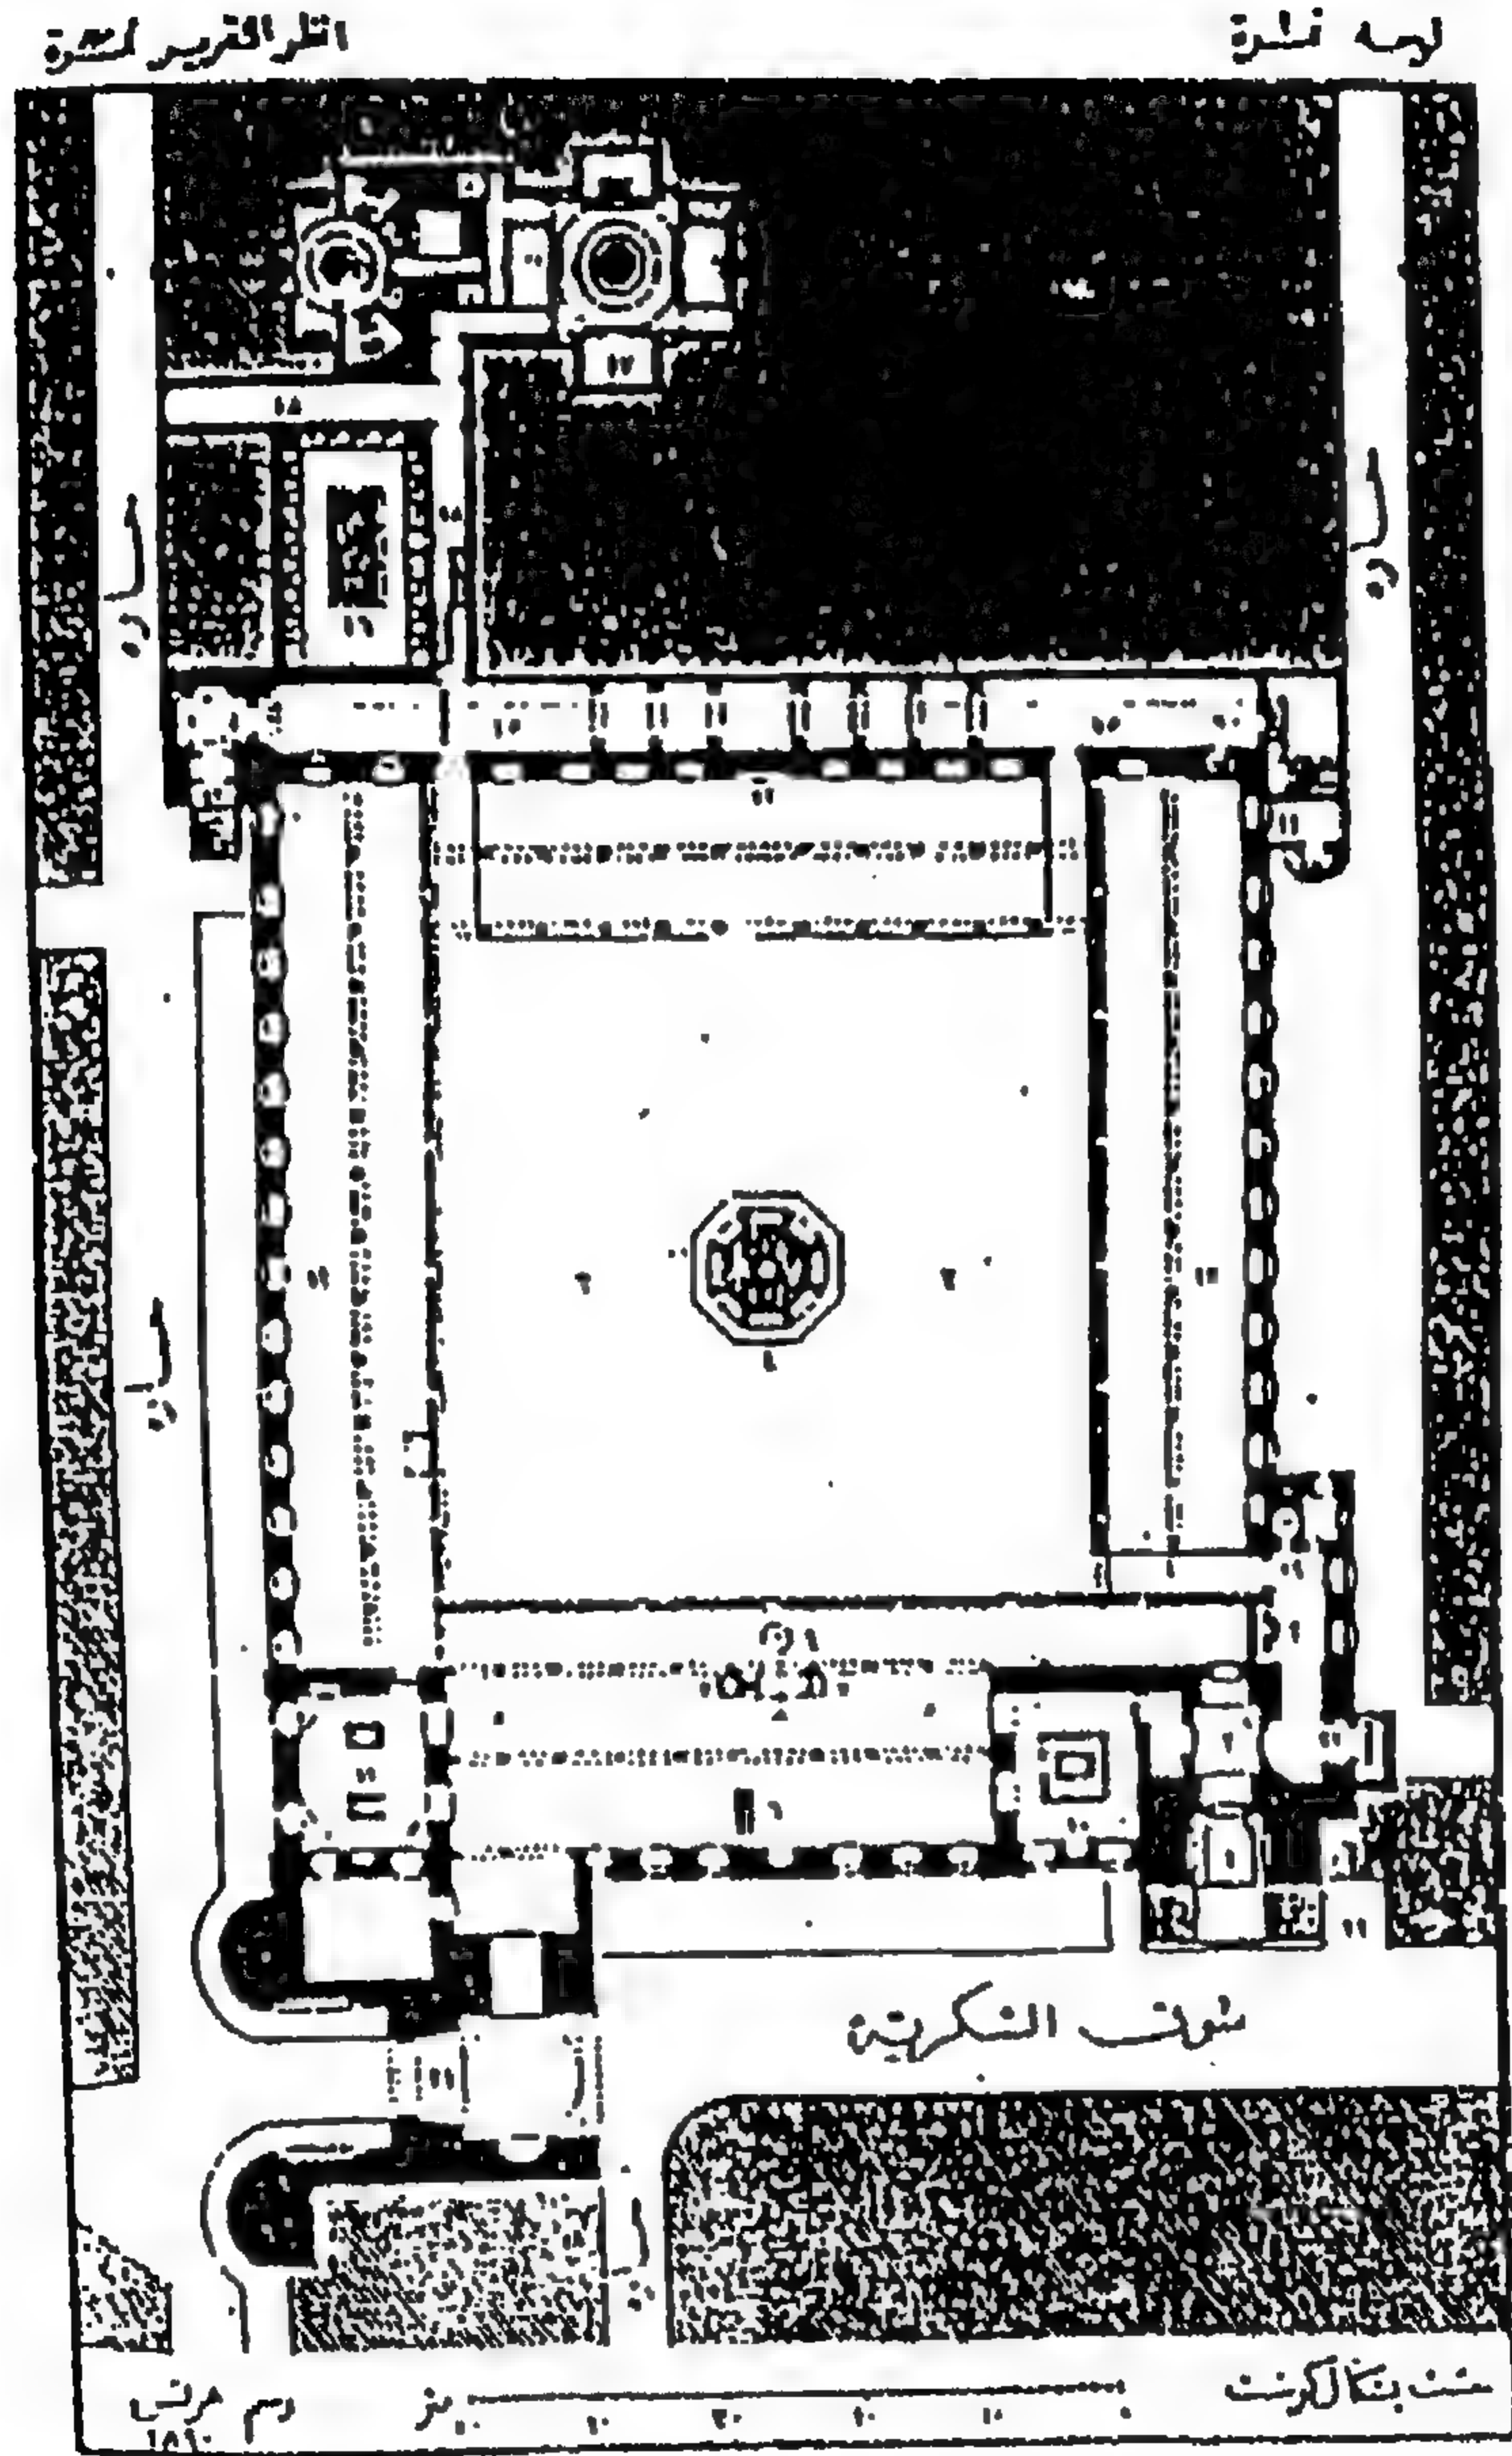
مسقط أفقي للجامع المنصوري الكبير
